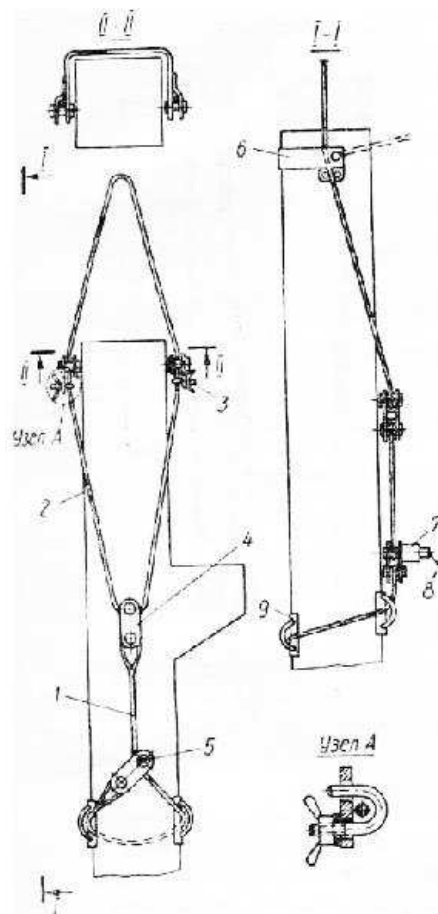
в – Строп-захват для монтажа колонн
